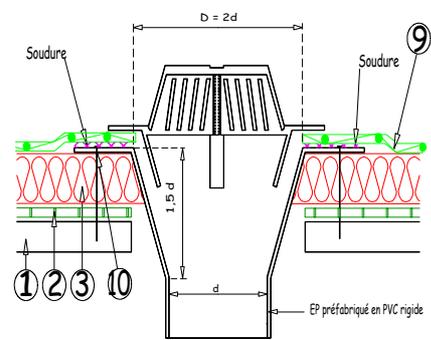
Entrée d'eau pluviale préfabriquée en PVC
